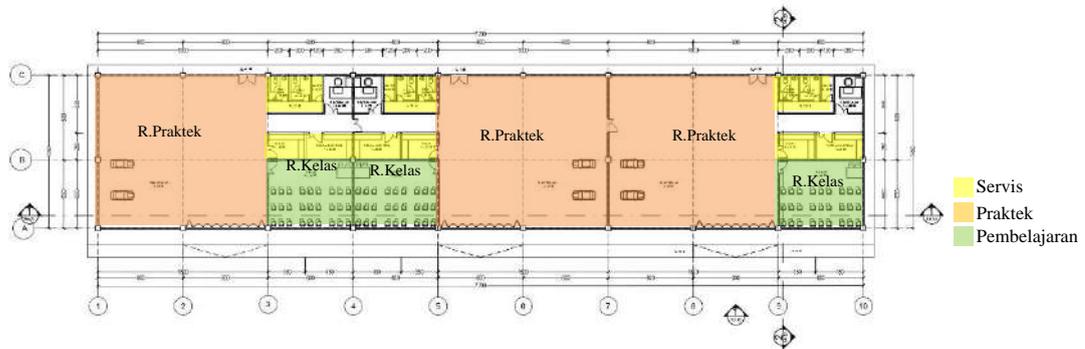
Denah lantai dasar gedung ekstrakurikuler
